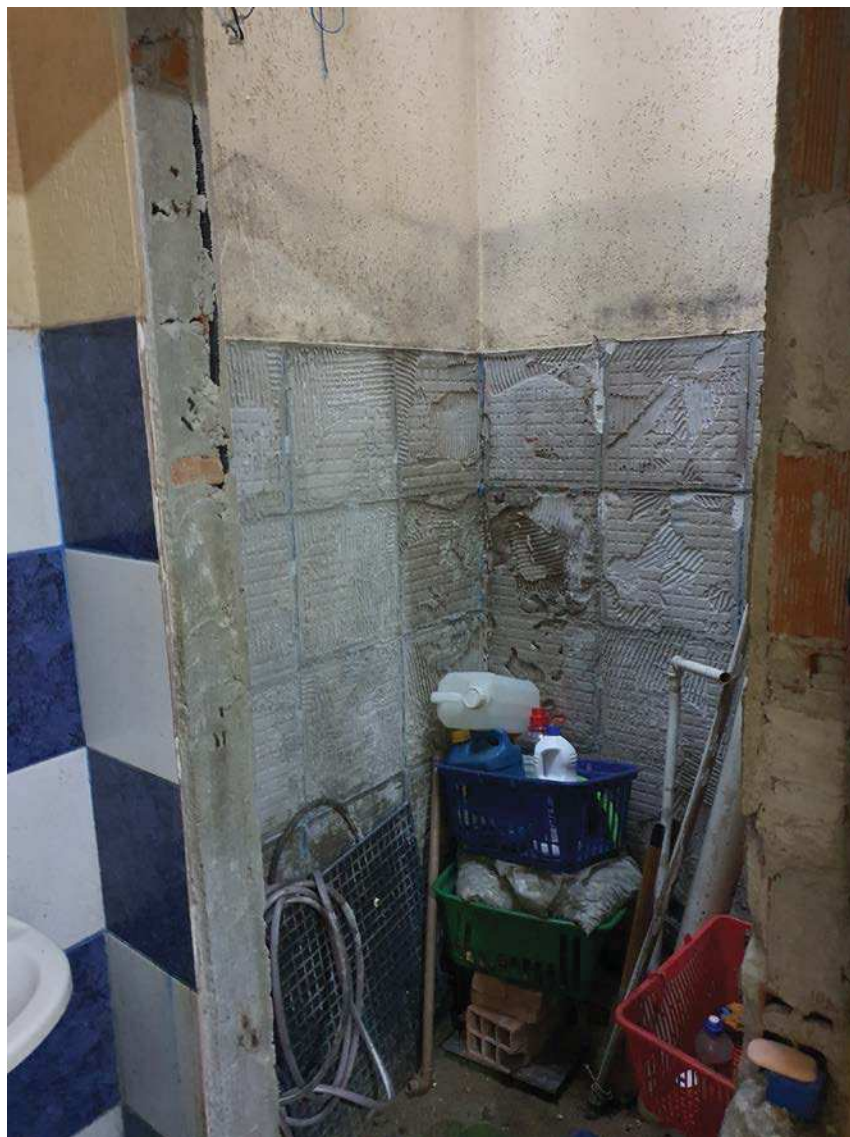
SANITARIO DEMOLIDO NO INTERIOR DA LOJA.
